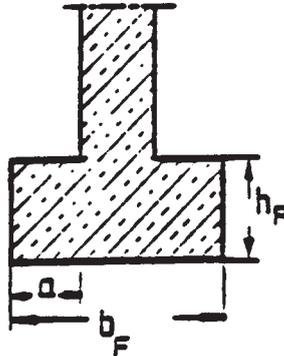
Unbewehrtes Stützenfundament; Bezeichnungen
